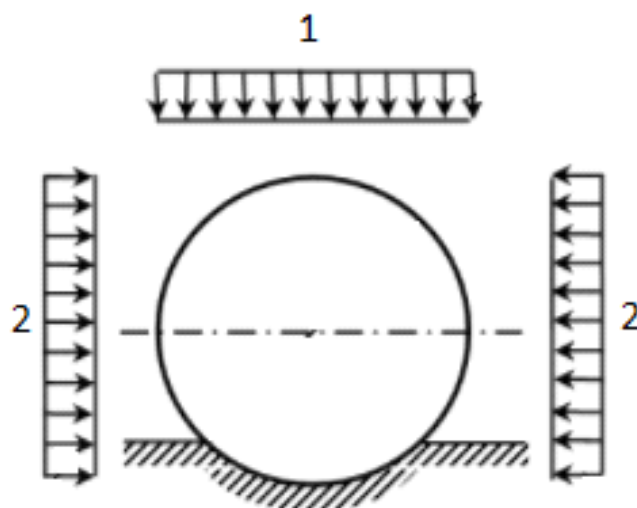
Принципиальная схема механической нагрузки на трубопровод
